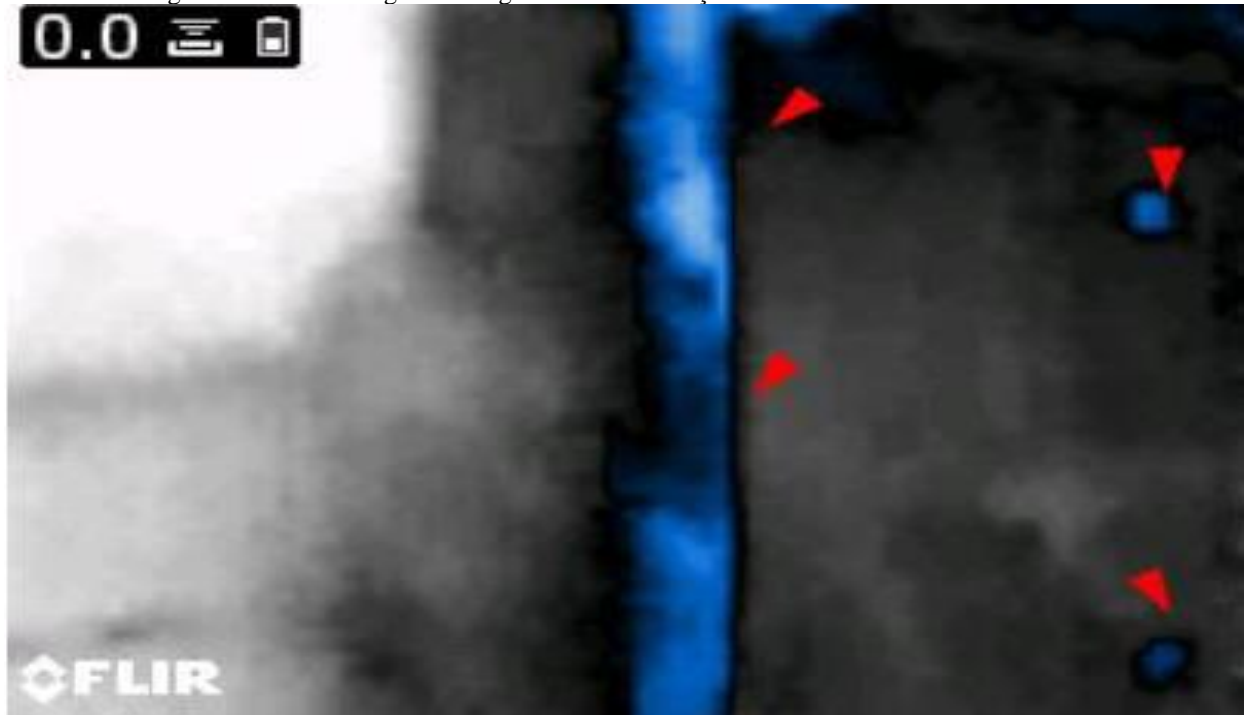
Vista da face da fachada do 1º andar com reparos construtivo
